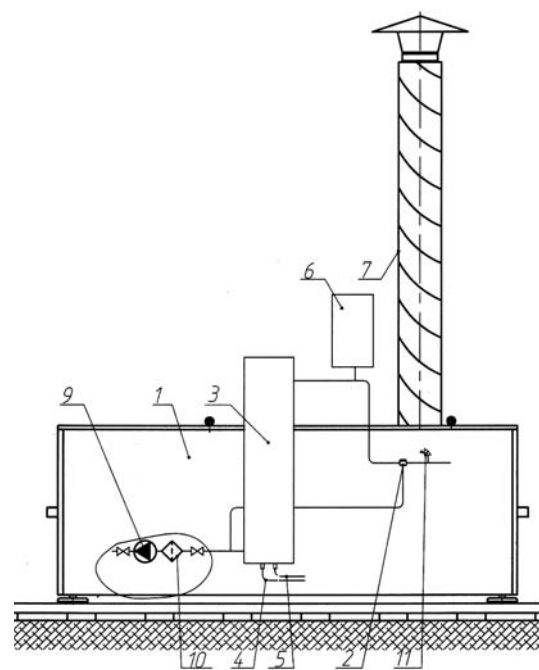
Схема установки котла КСВ для автономной системы горячего водоснабжения: 1 – котел КСВ; 2 – автоматический трехходовой кран; 3 – подогреватель ПВ; 4 – подвод холодной воды; 5 – вывод горячей воды; 6 – расширительный бак; 7 – дымовая труба; 8 – кронштейн; 9 – насос; 10 – фильтр; 11 – предохранительный клапан
